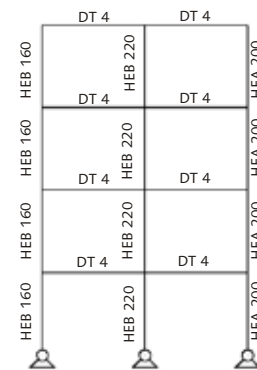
Grundriss Rahmen I - Haus 2
